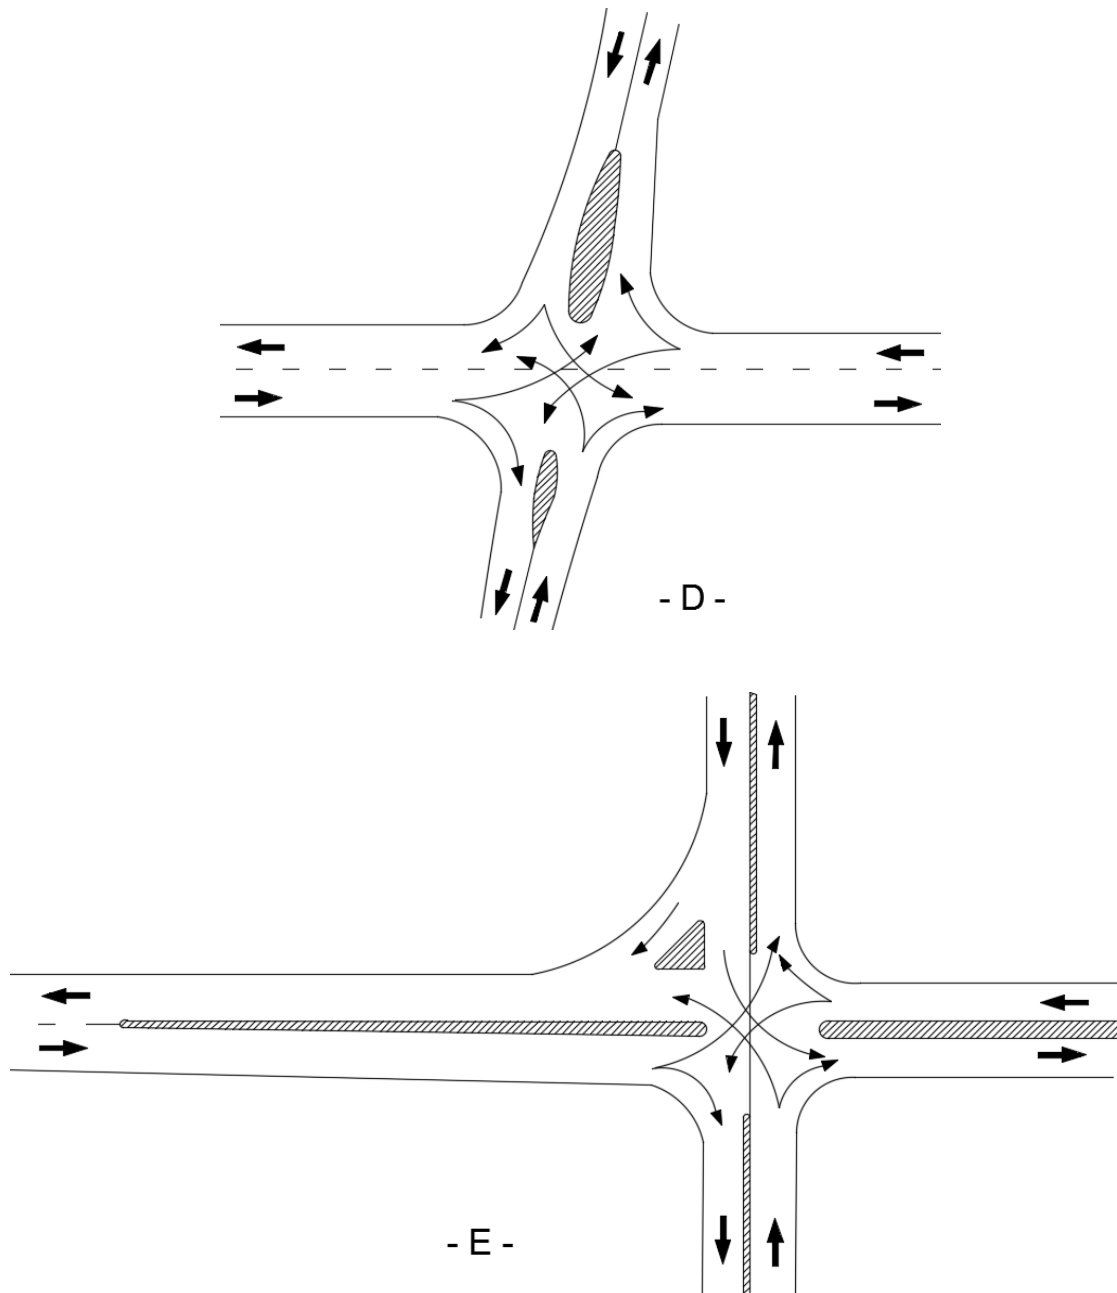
D,E Intersecciones de cuatro ramas canalizadas
